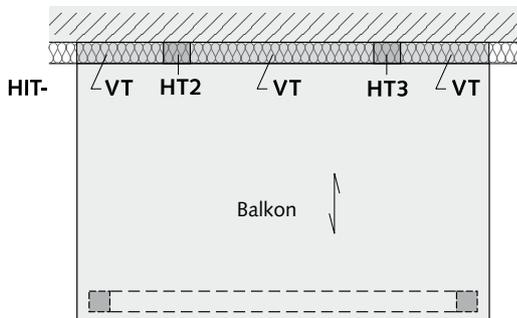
Gelenkig gelagerter Balkon auf Stützen. Zur Aufnahme von planmäßigen Horizontallasten werden HIT-HT Elemente eingesetzt.
